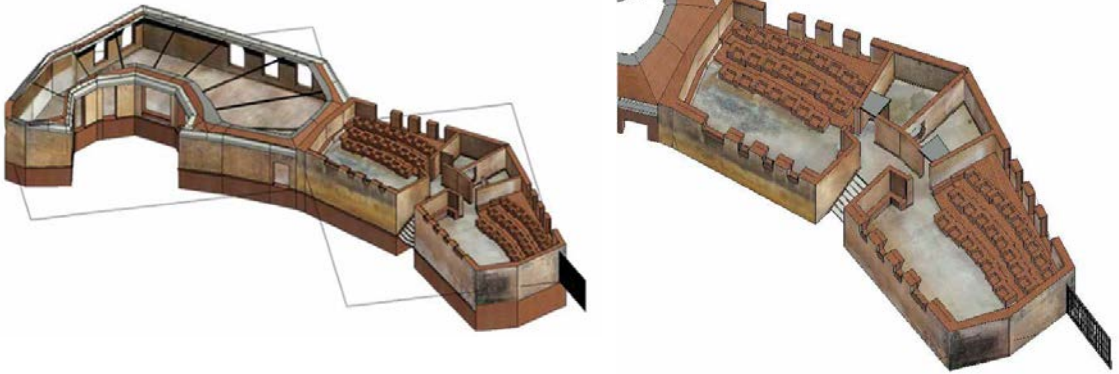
| Secciones horizontales 3D con inserción de fotoplanos de pavimentos y muros interiores. | Sezioni orizzontali 3D con inserimento dei fotopiani relativi a pavimenti a pareti interne.
